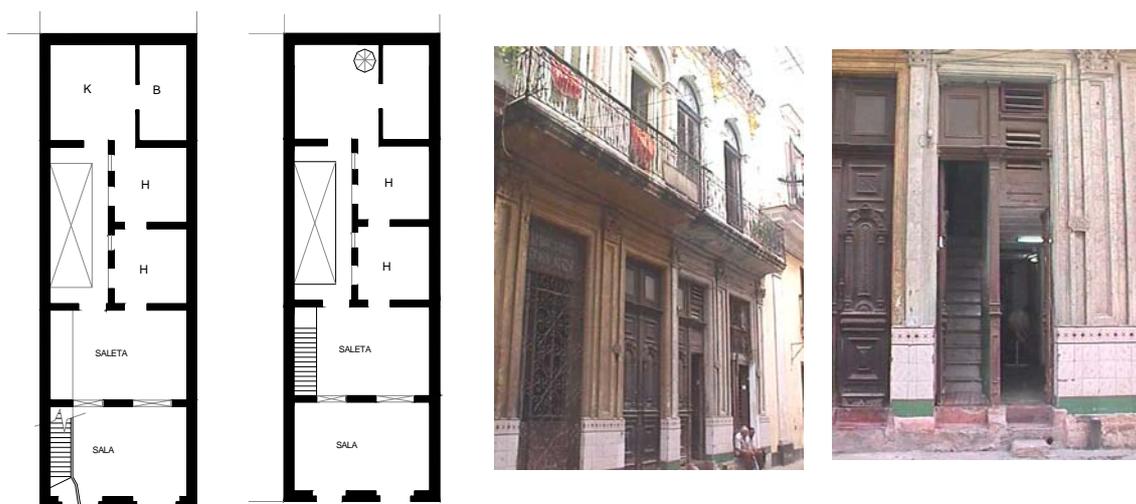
Habana 162, casa gemela con el 164. Plantas, fachada y detalle de accesos
